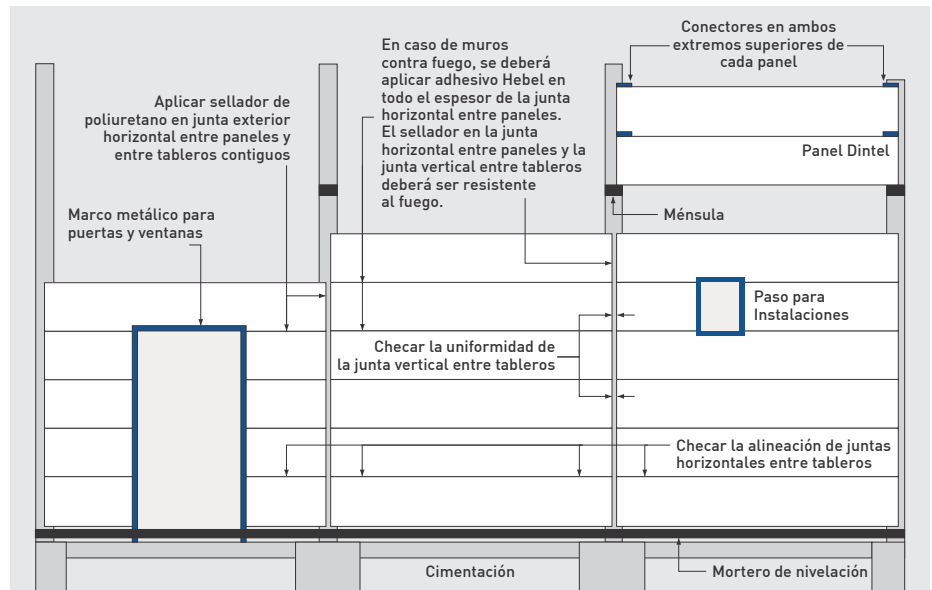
Tableros tipo con arreglo horizontal de paneles para muro sobre estructura de acero.
